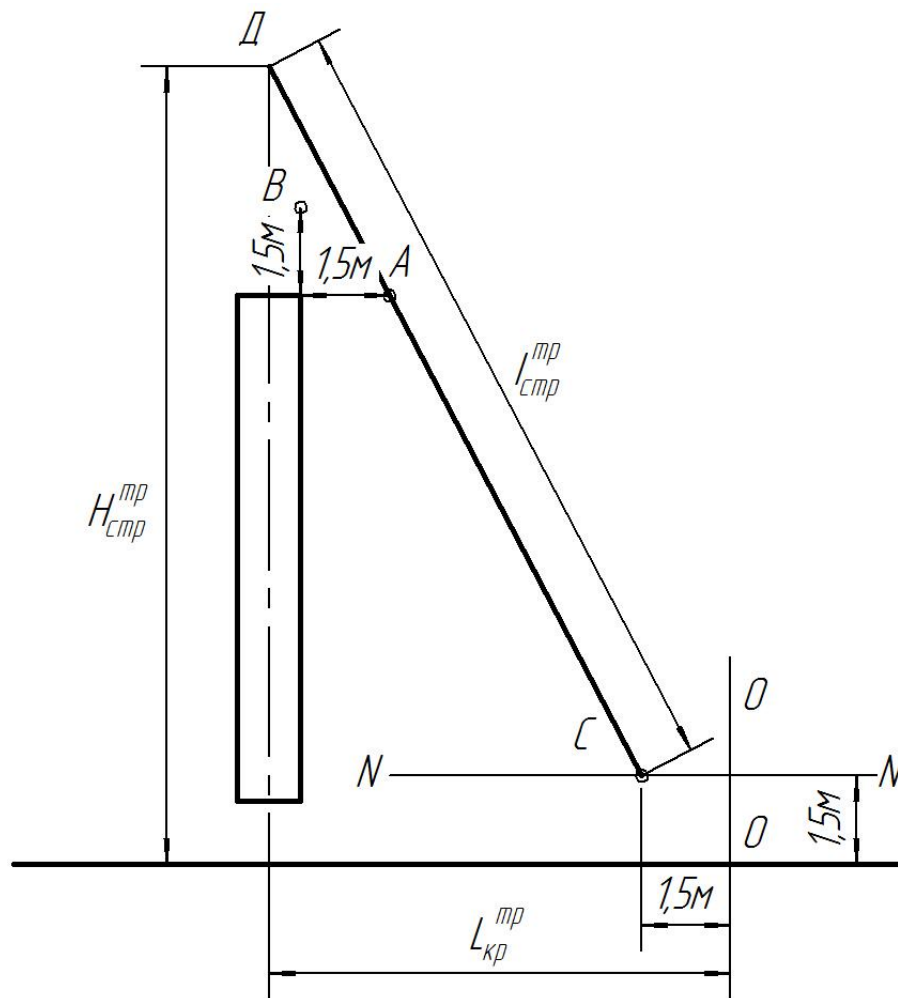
Схема определения параметров крана при монтаже колонн
